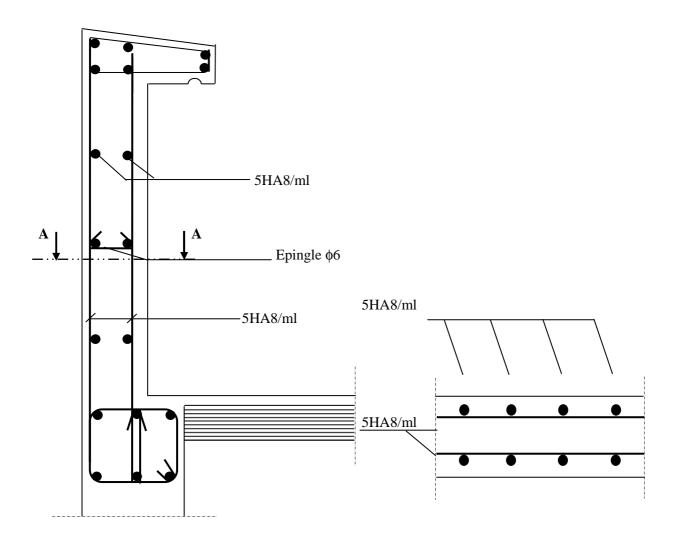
Plan de Ferraillage de l'acrotère.
